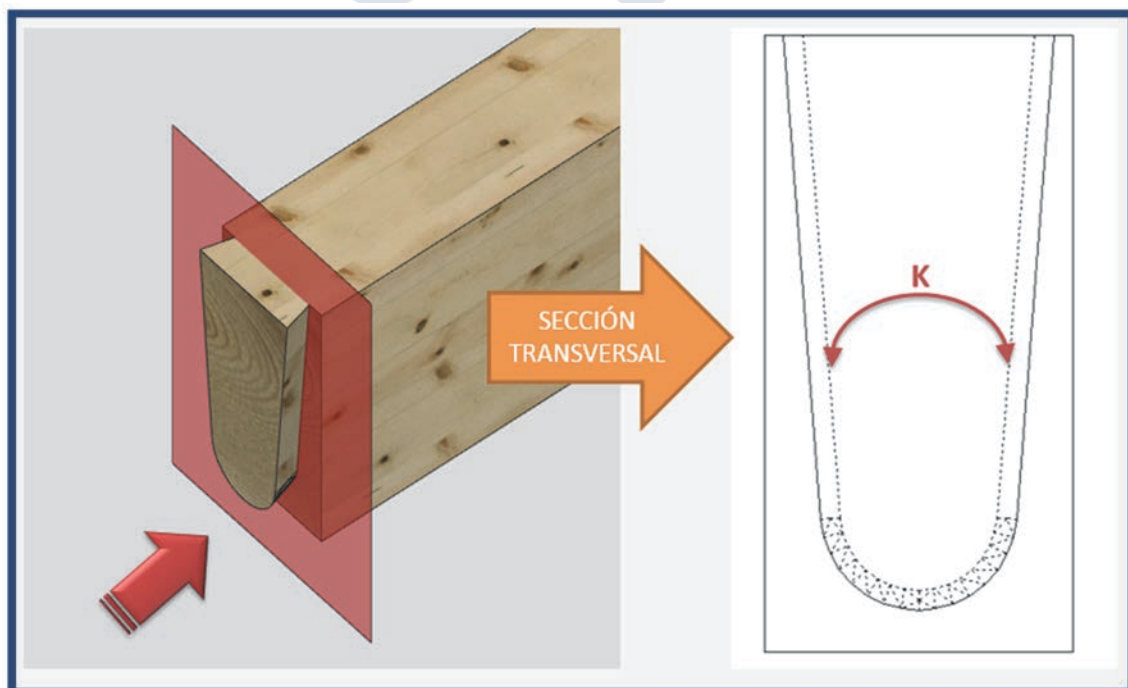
Ángulo “K” entre los flancos de la espiga en el plano de la testa de la viga
